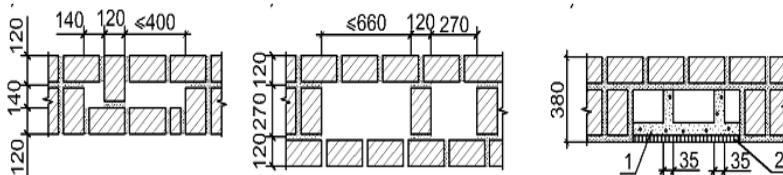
Размеры вентиляционных и дымовых каналов в кирпичных стенах:
